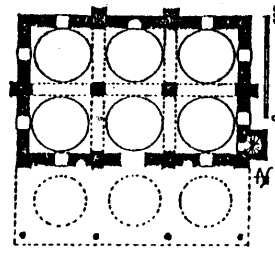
مسقط أفقي لجامع بابا آدم في رامبال بالبنغال (عن : Michell) .
